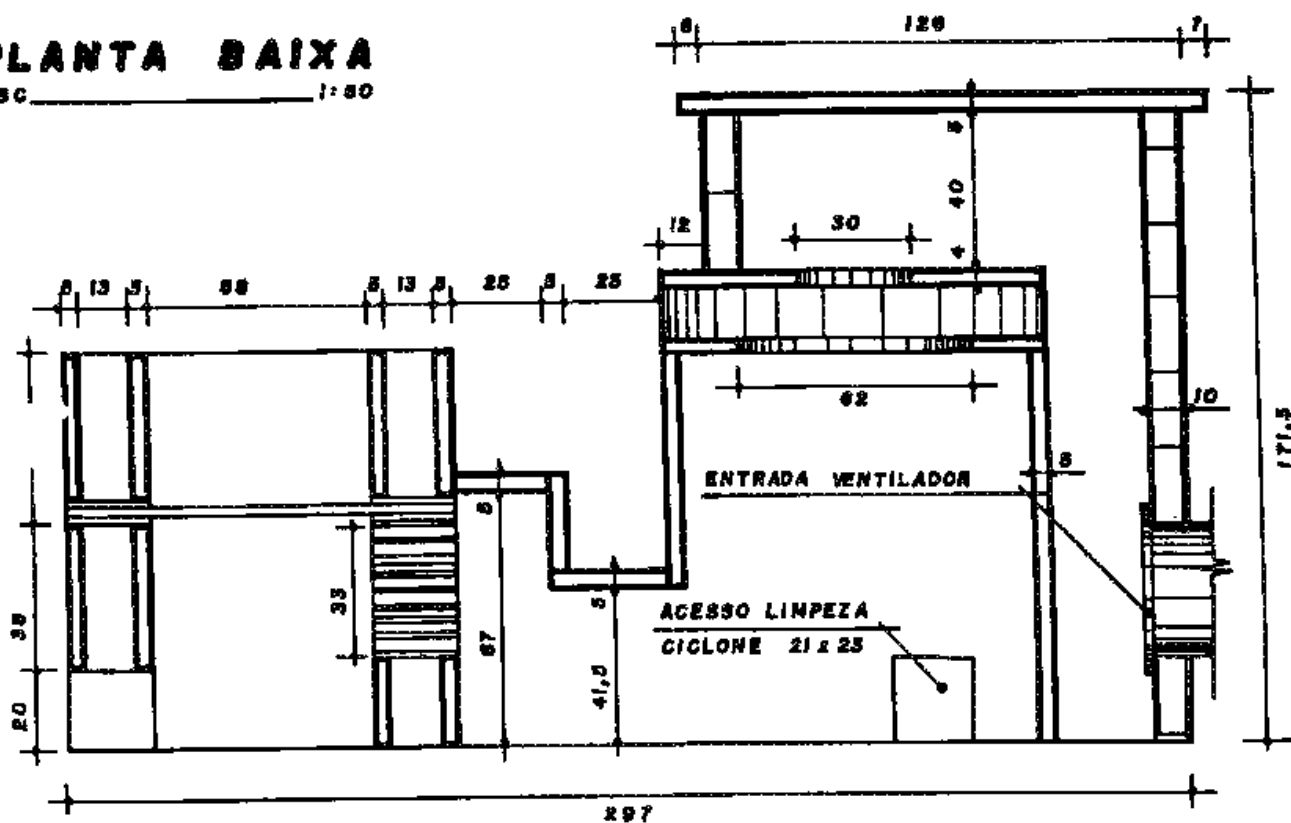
Vista geral do secador de chapas pré-fabricadas a base de cimento
